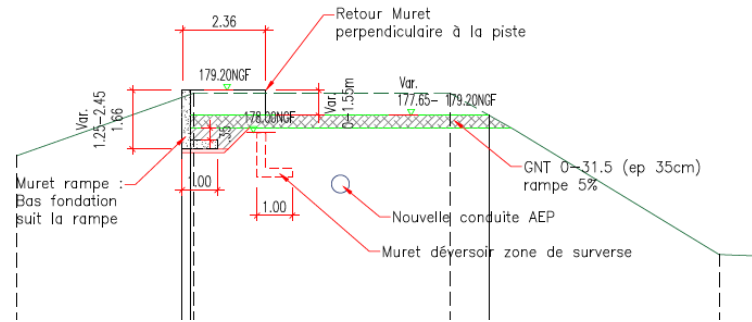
Coupe type - Muret BA 179.20 de part et d'autre de la zone de surverse
